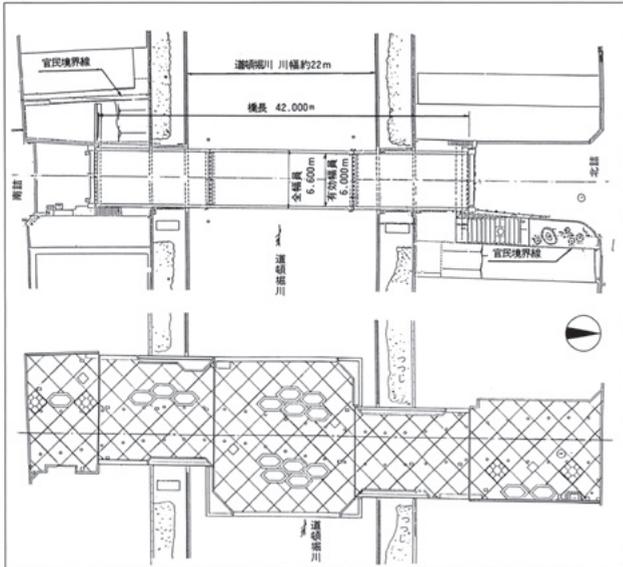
整備前の平面図(上)、整備後の平面図(下) (第一次改修)
